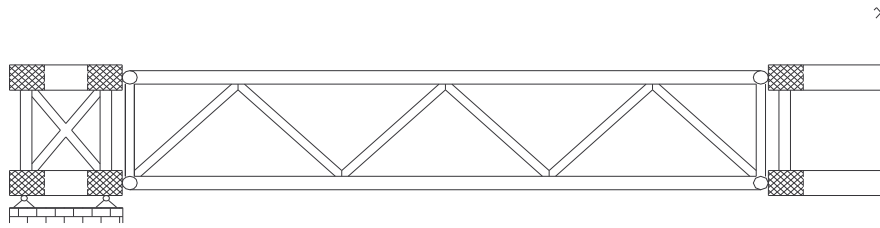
Speiche als Fachwerkträger mit konstanter Höhe; mit biegesteifem Anschluss zur Unterkonstruktion
